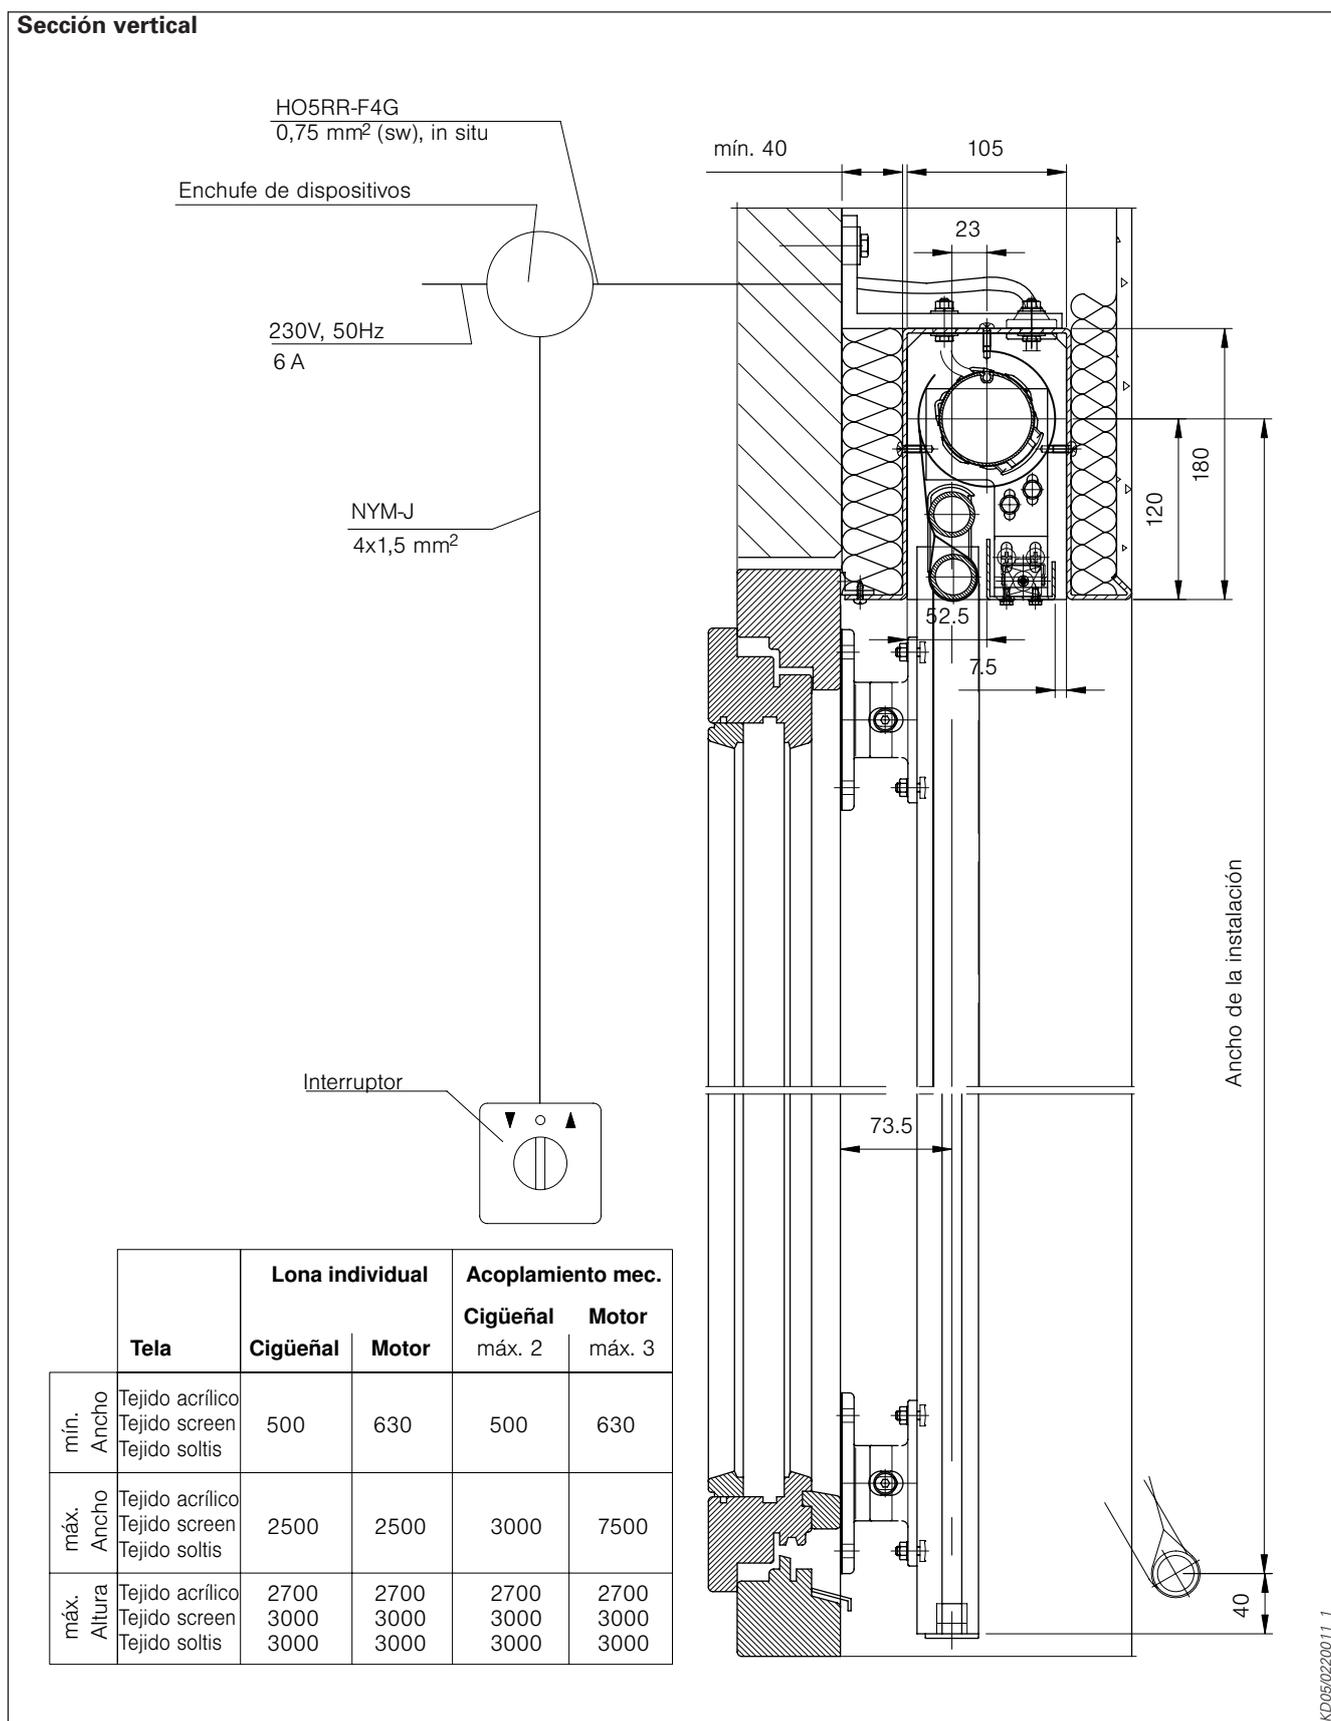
Sección vertical marquisoleta Modelo 109 E con carril redondo Ø35 en fachada con aislamiento térmico
